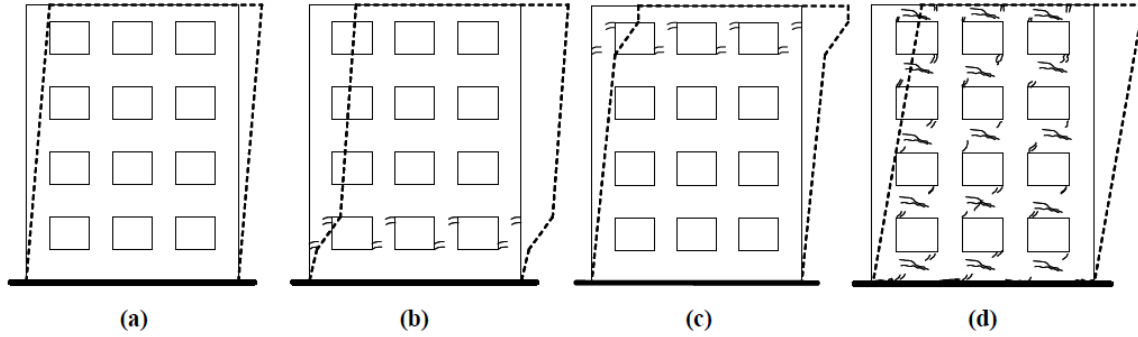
Perfiles de falla en el plano para diferentes estados límite (Restrepo, 2003)
